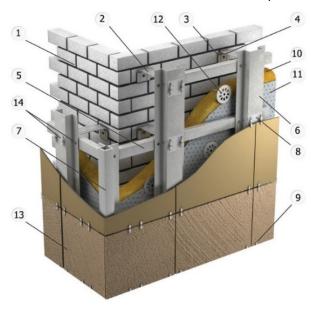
Общий вид конструкции навесного вентилируемого фасада:
